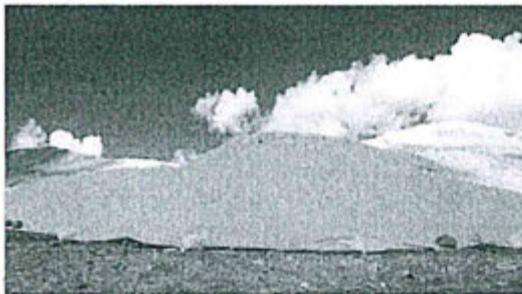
Vista panorámica 2 del Depósito de Stock Pile Top Soil recubierto con membrana plástica
